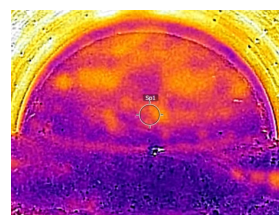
鏡吹付け施工後の切羽 (赤外線画像)
